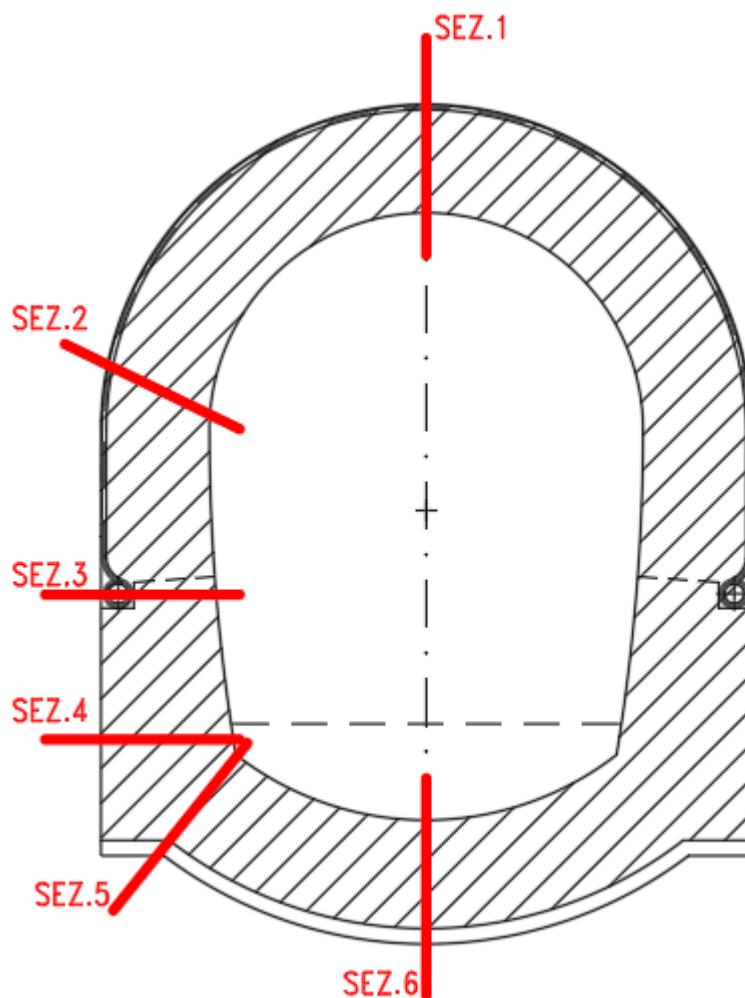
Sezioni di verifica – galleria d'emergenza
